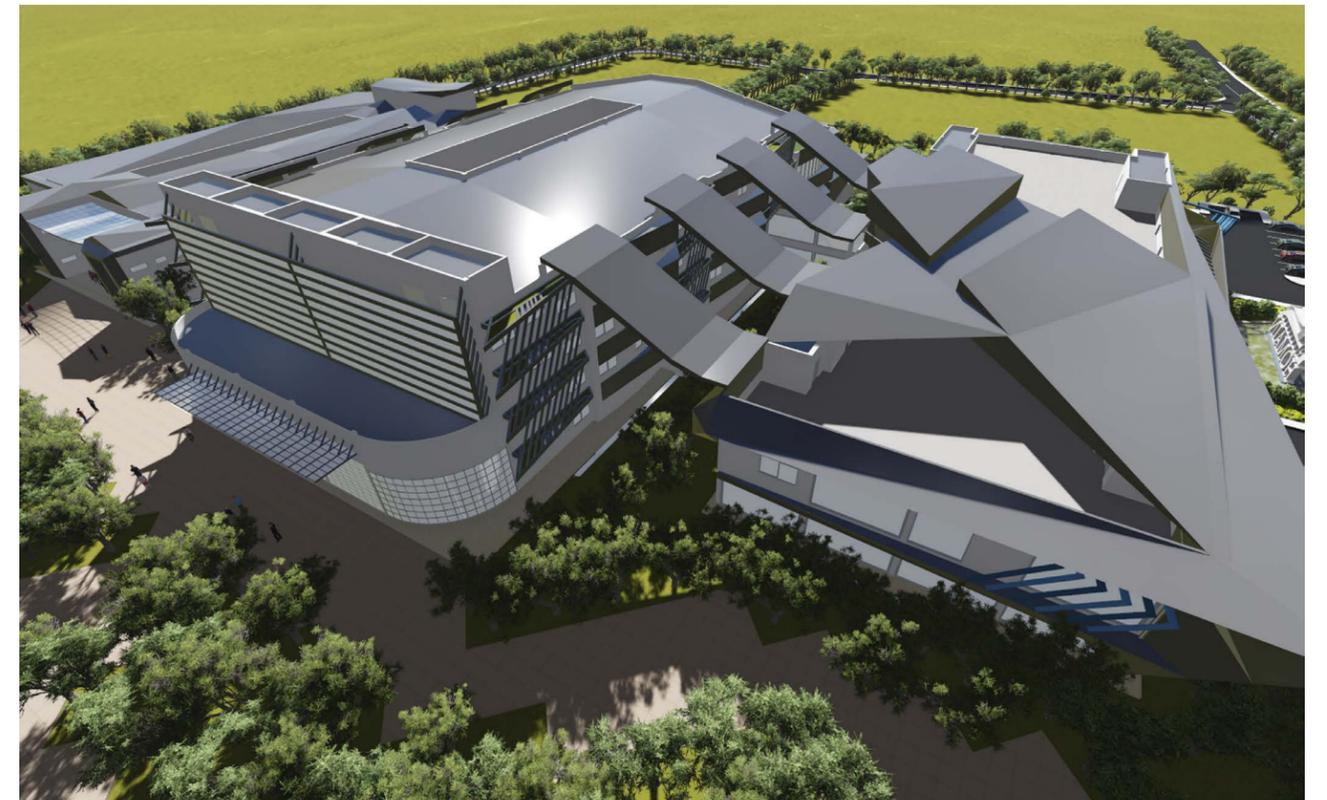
Plaza de distribución. Fuente: Elaboración propia
